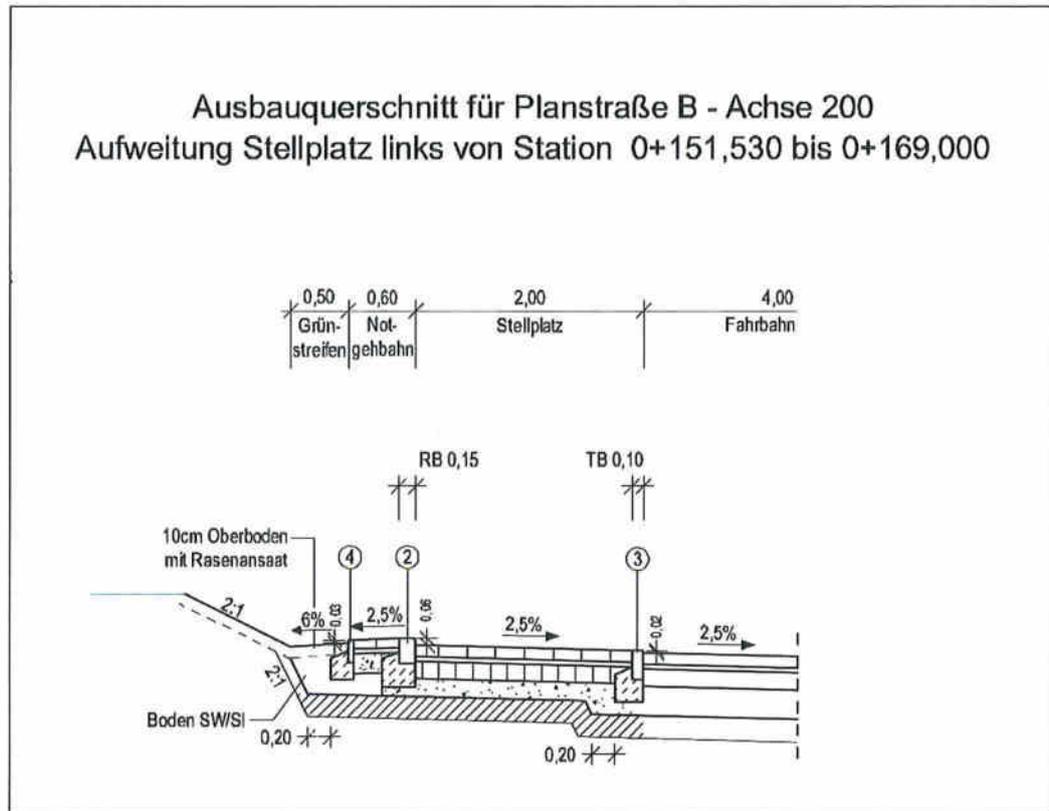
Empfehlung für den Straßenquerschnitt – Fahrbahn mit straßenbegleitendem Parken im Einmündungsbereich (Quelle: Ausführungsplanung, IBL Schwerin –Ingenieurbüro Leirich, Stand: 11/2022)
